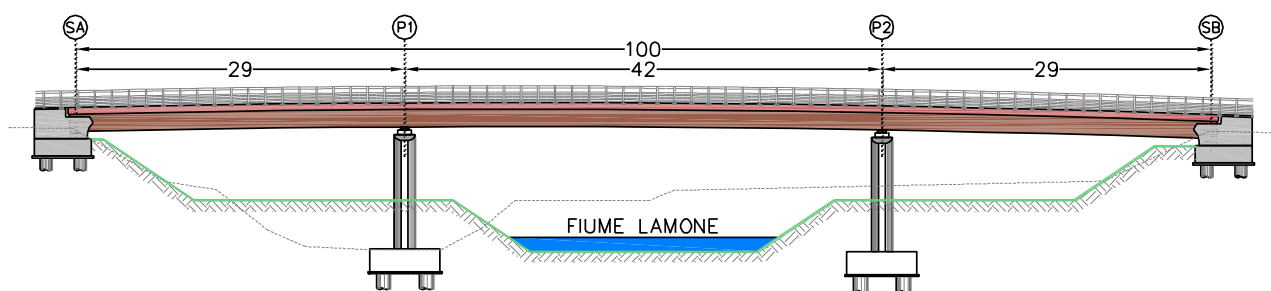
Prospetto del nuovo ponte sul fiume Lamone
